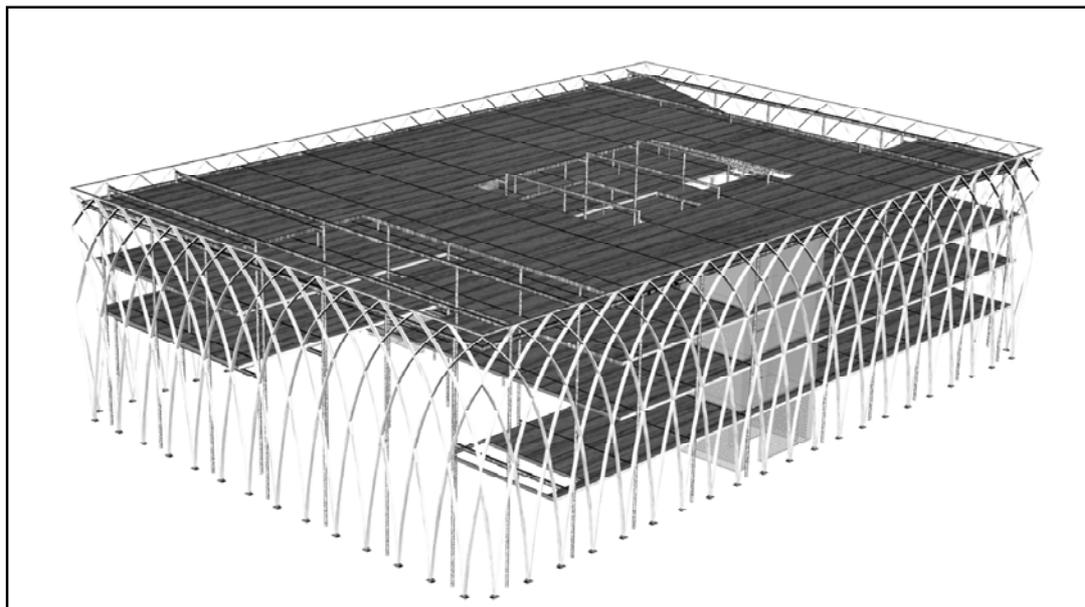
Isometrie mit Holzdecken und Rautenkonstruktion (VHT)
